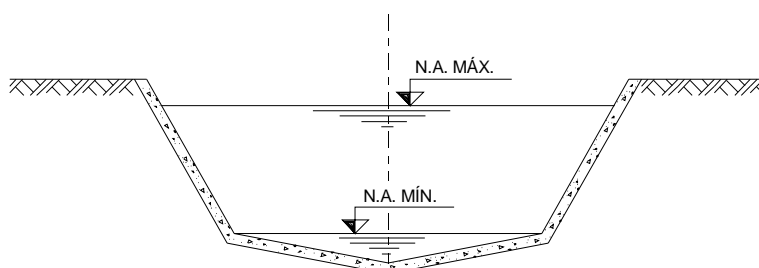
Canal em concreto – Seção trapezoidal mista.
